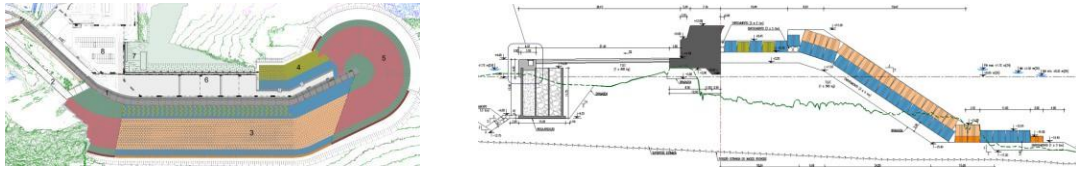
Traçado em planta (esquerda). Perfil transversal típico na zona do cais (direita).
